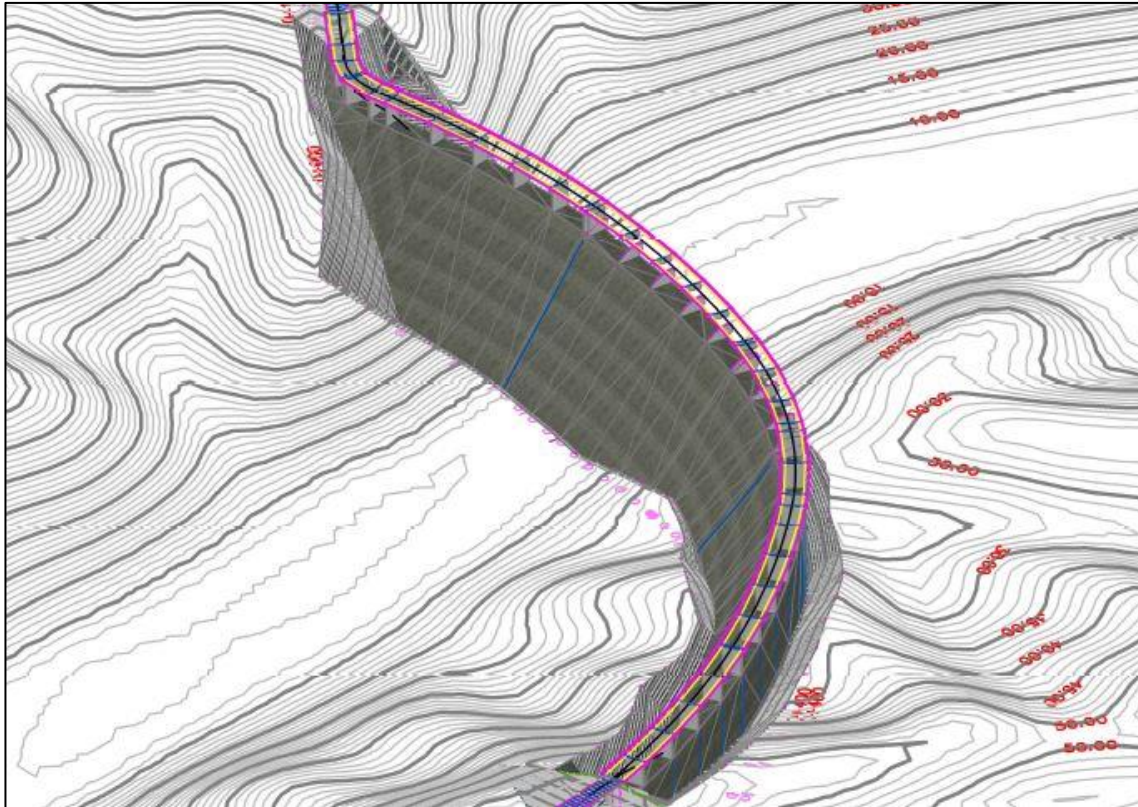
Vista 3D de la presa con material modelizado 'concrete' en la superficie de la presa.
